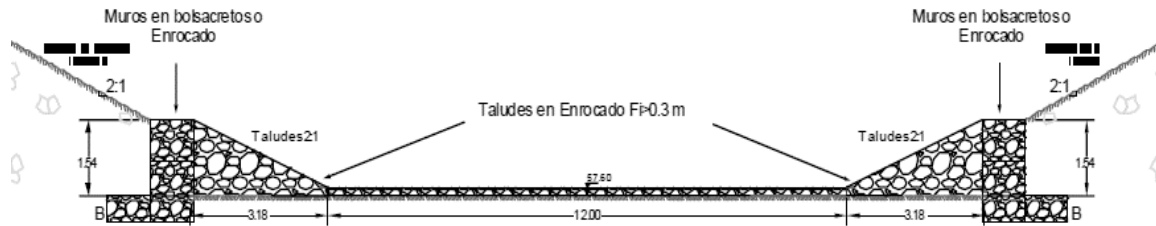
Sección transversal al inicio de la estructura de disipación de energía del Caño Piedras. Corte B-B.
